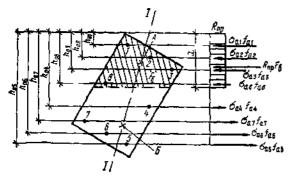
Схема усилий и эпюра напряжений в сечении, нормальном к продольной оси железобетокного элемента, в общем случае расчета по прочности
